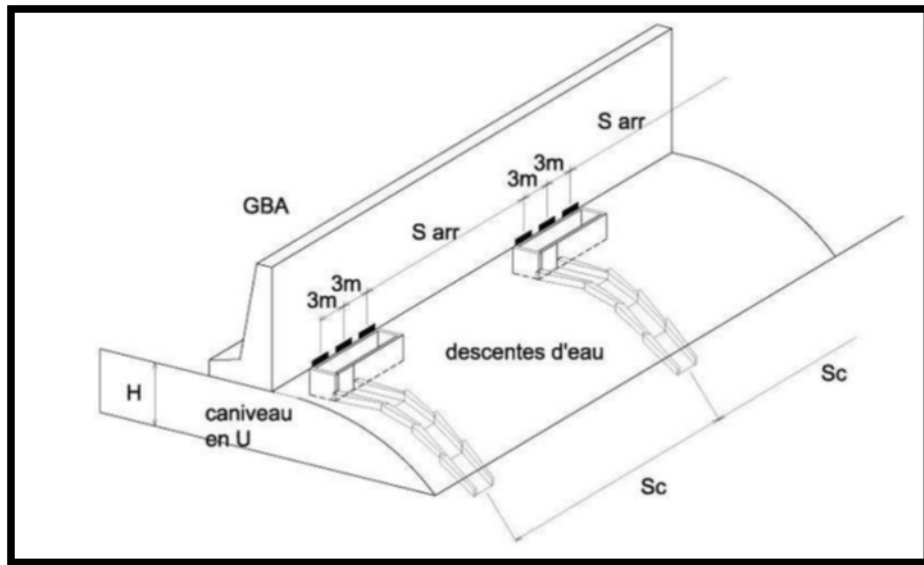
Alternative 1 d’implantation des ouvertures dans les GBA[29]
